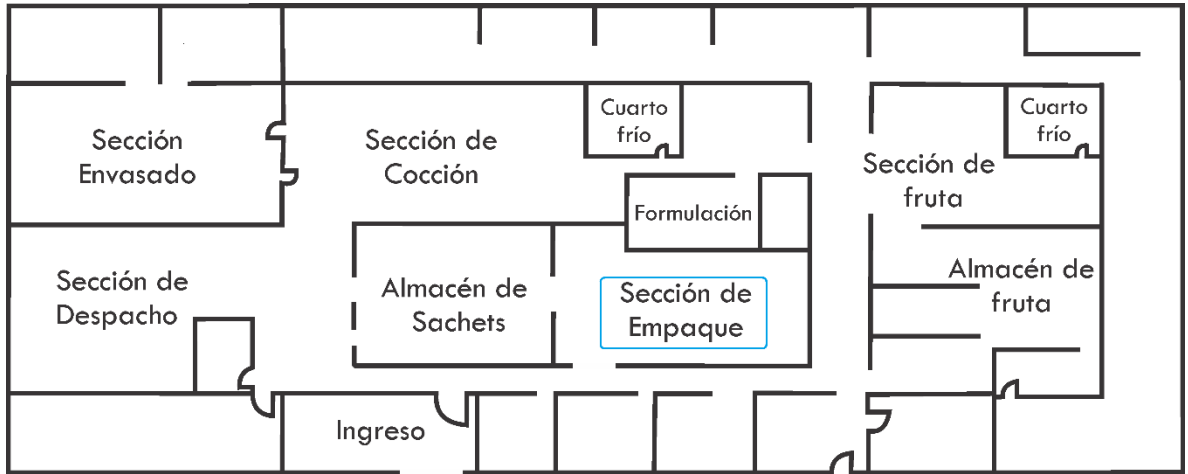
Plano básico de la distribución de las Secciones (Fuente Frutalia)
